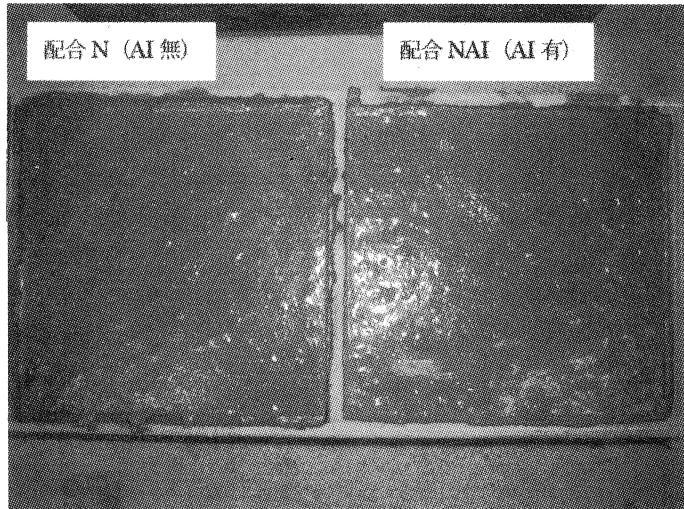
フレッシュコンクリート時の打設面のひび割れ性状
